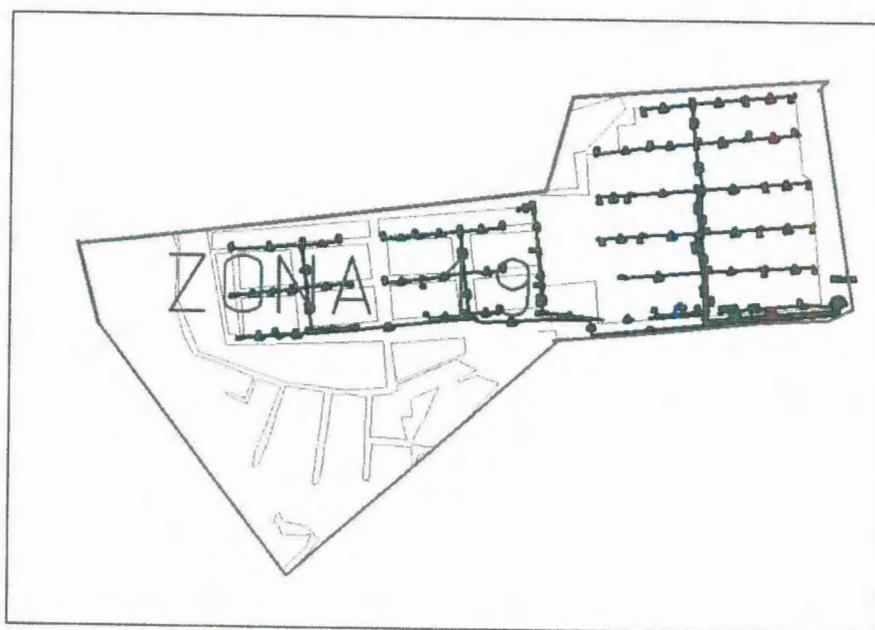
Planimetría zona 19 del sector de la vía a Daule
